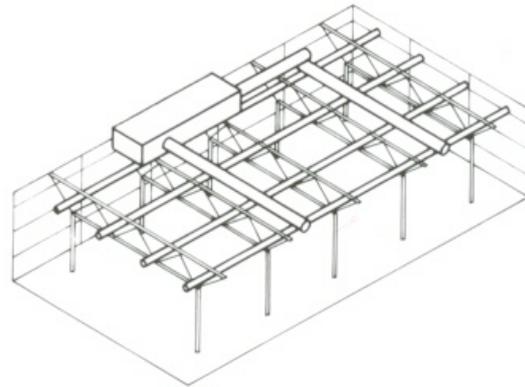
Stahltragelemente mit aufgelöstem Querschnitt
